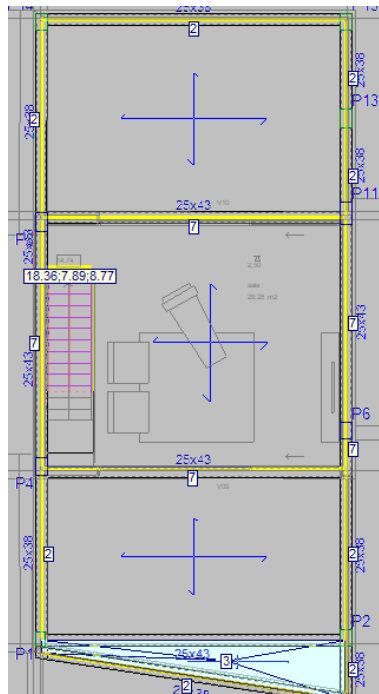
Lajes Maciças do Piso 2 (Fonte: CYPE)
